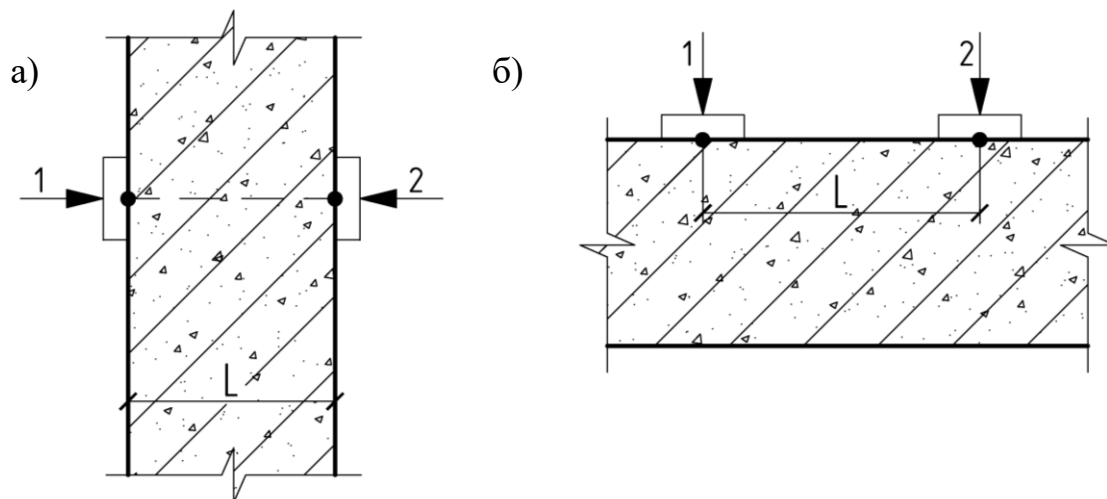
Способы сквозного (а) и поверхностного (б) прозвучивания изделий: 1,2 – точки установки преобразователей; L – база прозвучивания.
